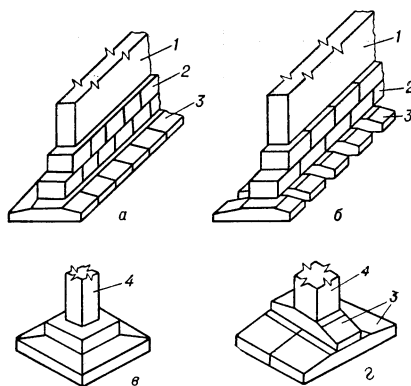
Сборные фундаменты: а — ленточный под стену; б — прерывистый под стену; в — стаканный под колонну; г — составной под колонну; 1 — стена здания; 2 — стеновой фундаментный блок; 3 — блок-подушка; 4 — колонна.
